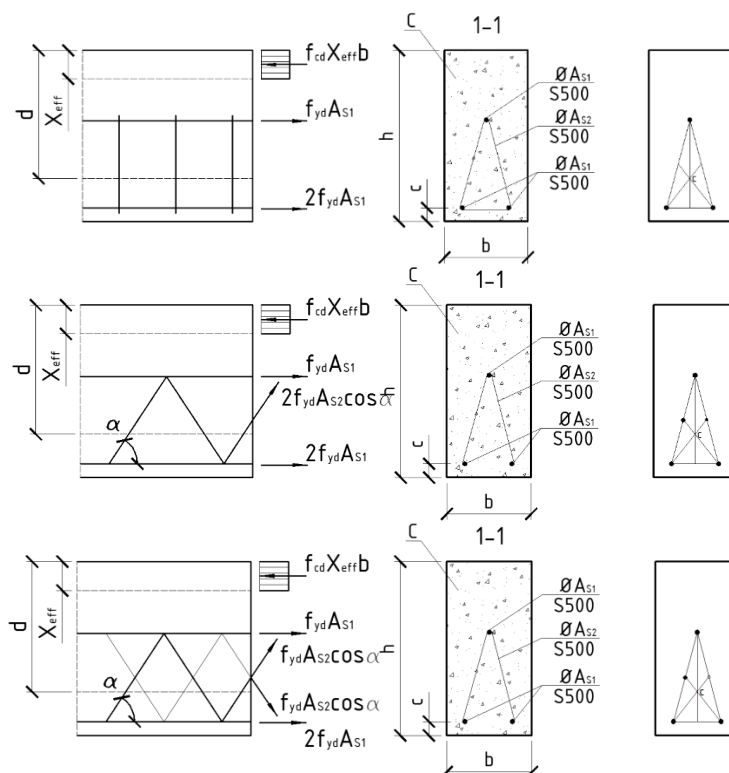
Схема усилий в сечении, нормальном к продольной оси изгибаемого железобетонного элемента
